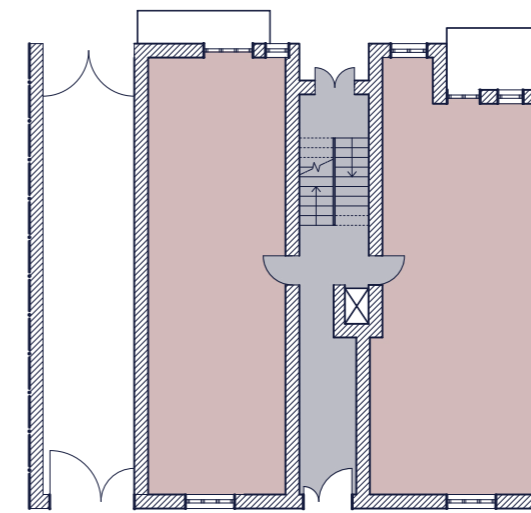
Zone termiche pianta piano rialzato, fuori scala.
